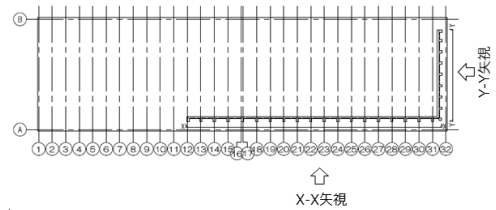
遮蔽壁の平面図 (10-C 貯蔵庫)
